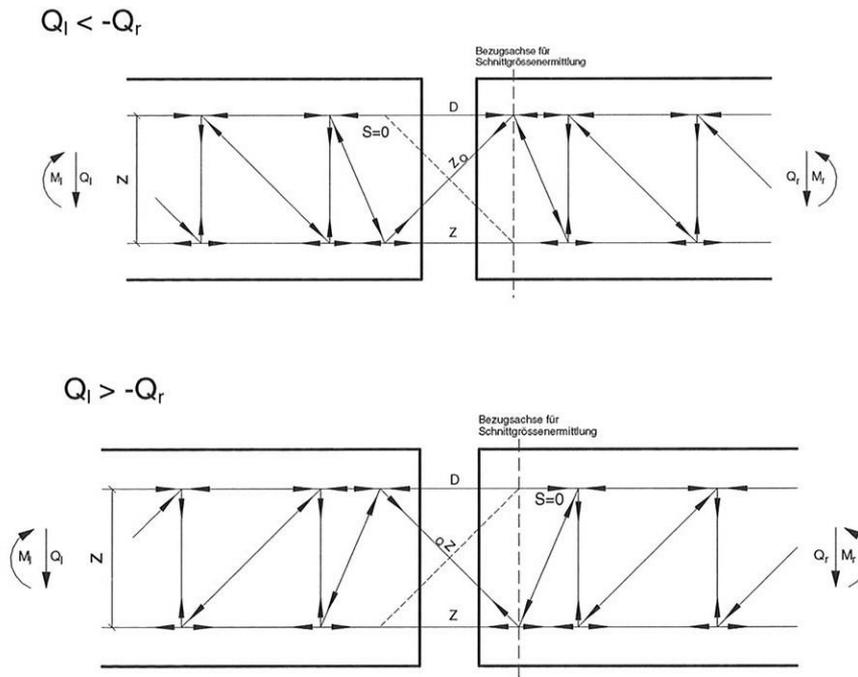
Egcobox Kragplattenelement Fachwerkmodell Typ P +/-
